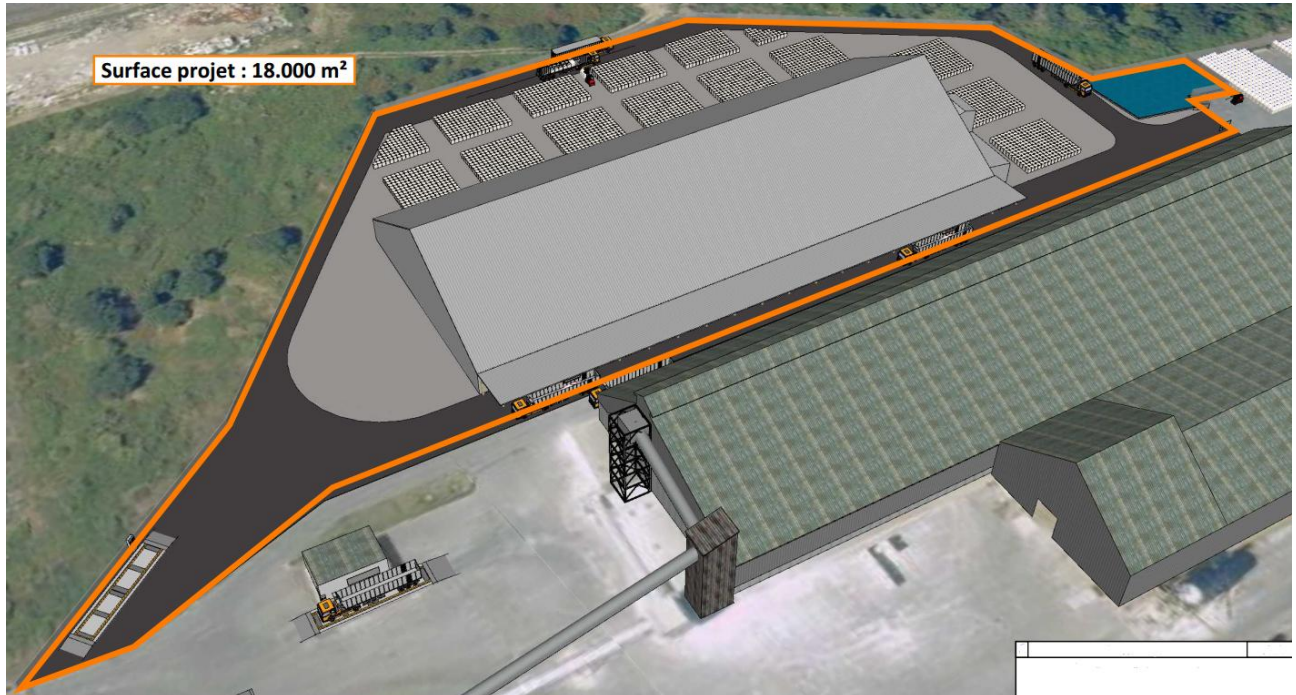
Plan projet 2021 (source : Maître d'Ouvrage)
